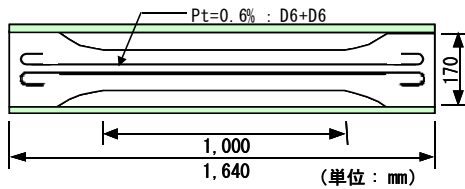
JIS改良型一軸拘束ひび割れ試験体の概要
